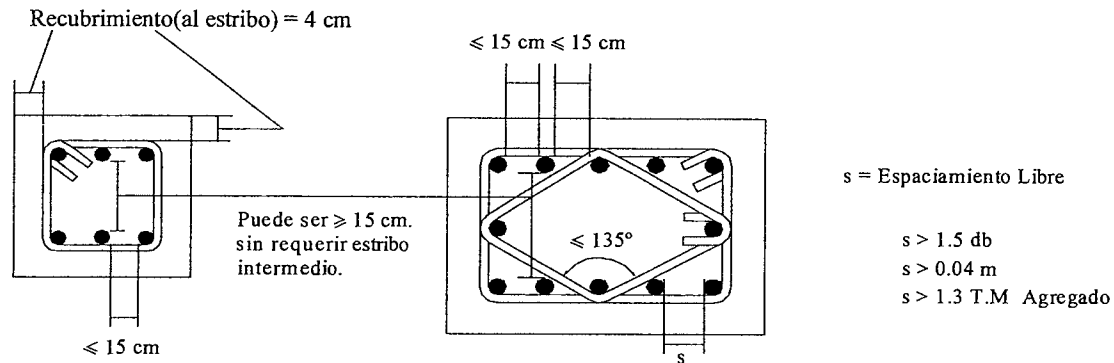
Disposiciones de la Norma relacionadas con la colocación del refuerzo en columnas.
